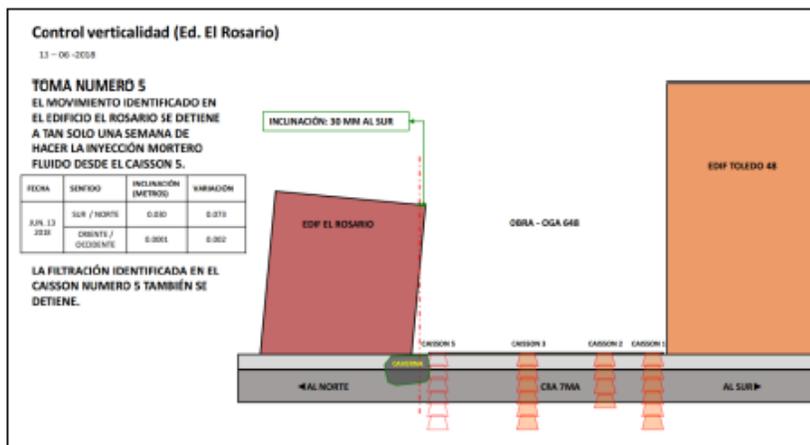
Tomado de Anexo 4. Esquemas de excavación-Cimentación/Ilustración Verticalidad suministrado por Edificio
